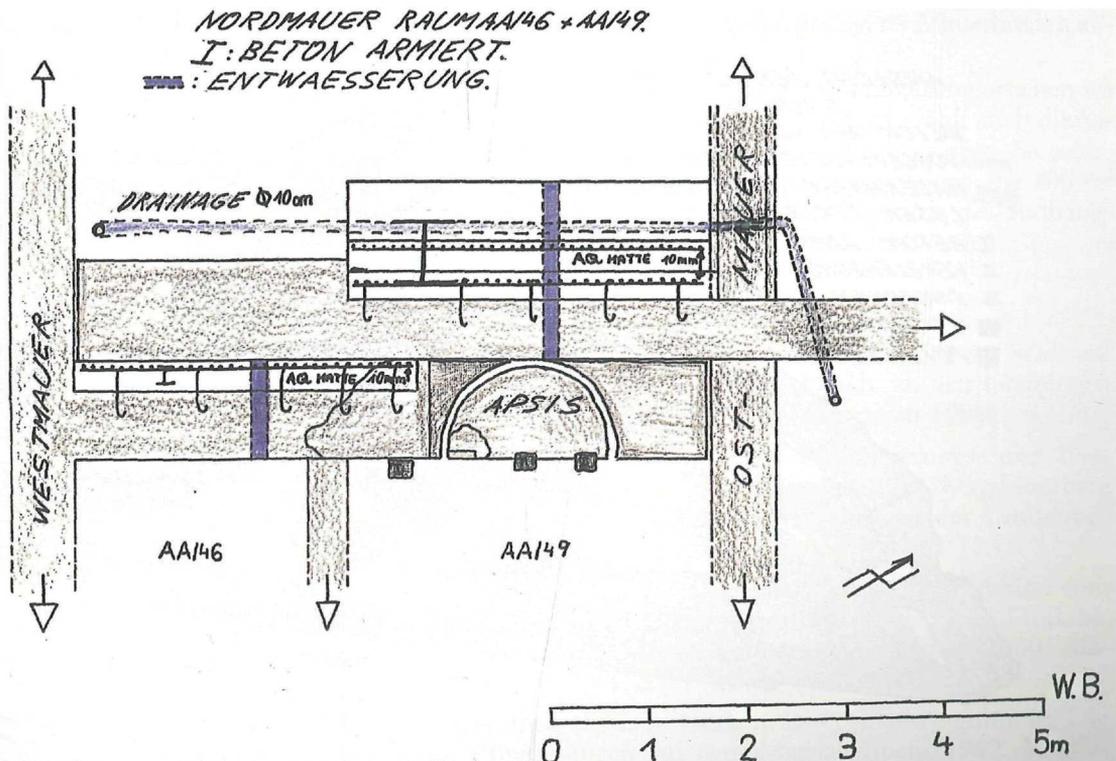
Grundriss zur Konservierung der Nordmauer AA/46 und AA/49; Zeichnung W. Buxbaumer
